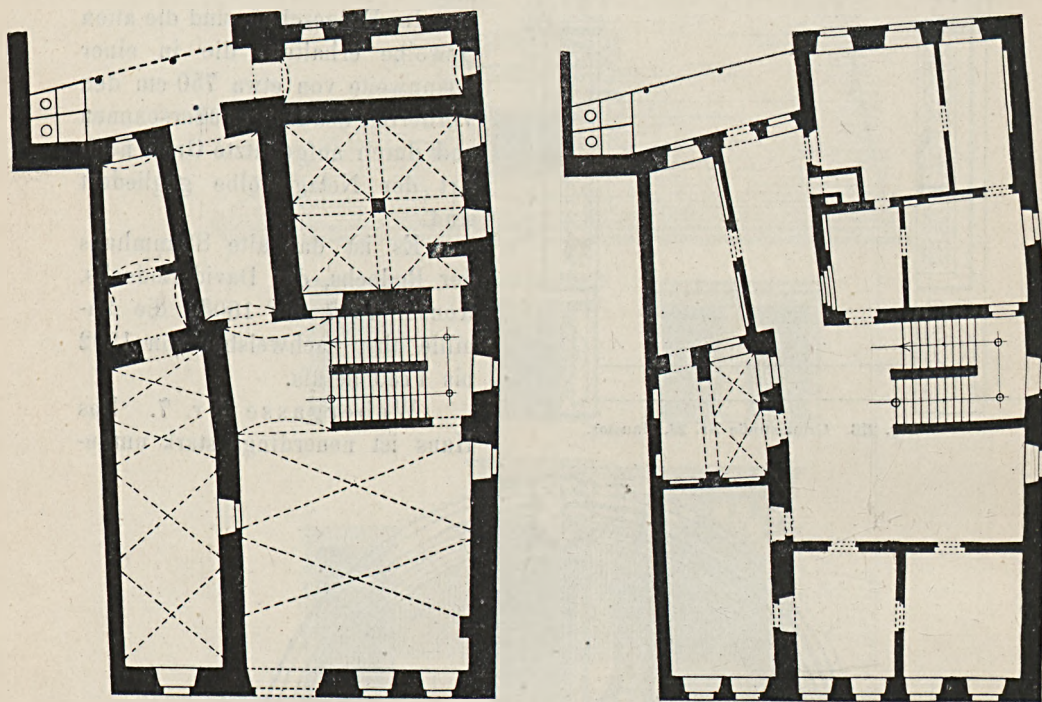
und 219. Webergasse Nr. 7, Grundriß vom Erdgeschoß und Obergeschoß.
